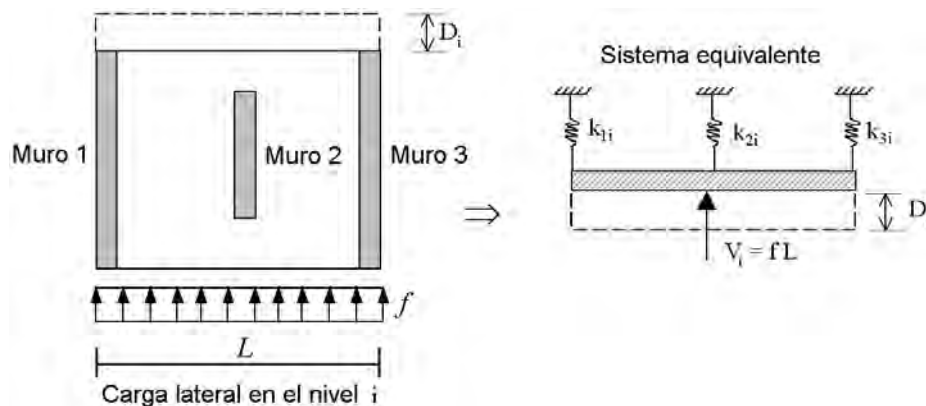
Distribución de fuerzas laterales en planta del método simplificado.
